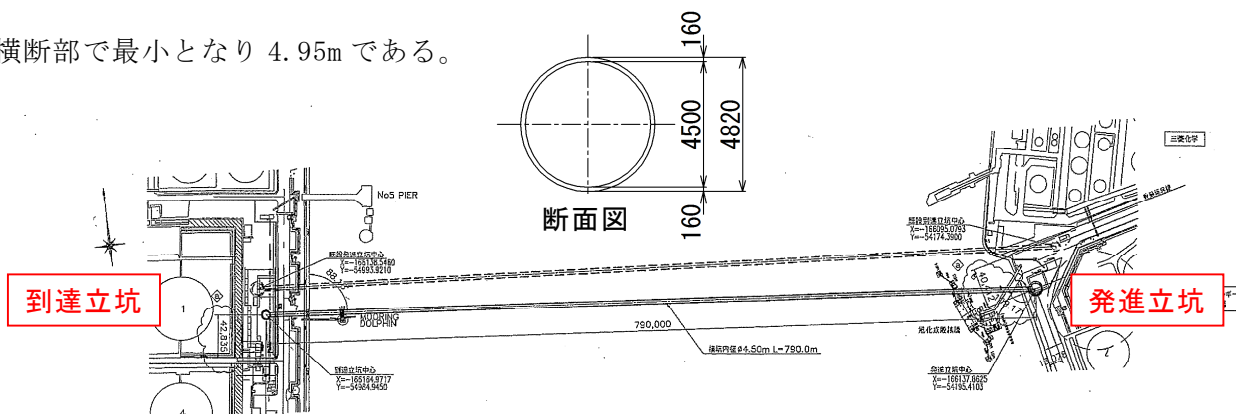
断面図、平面図（鹿島建設(株)資料より）
